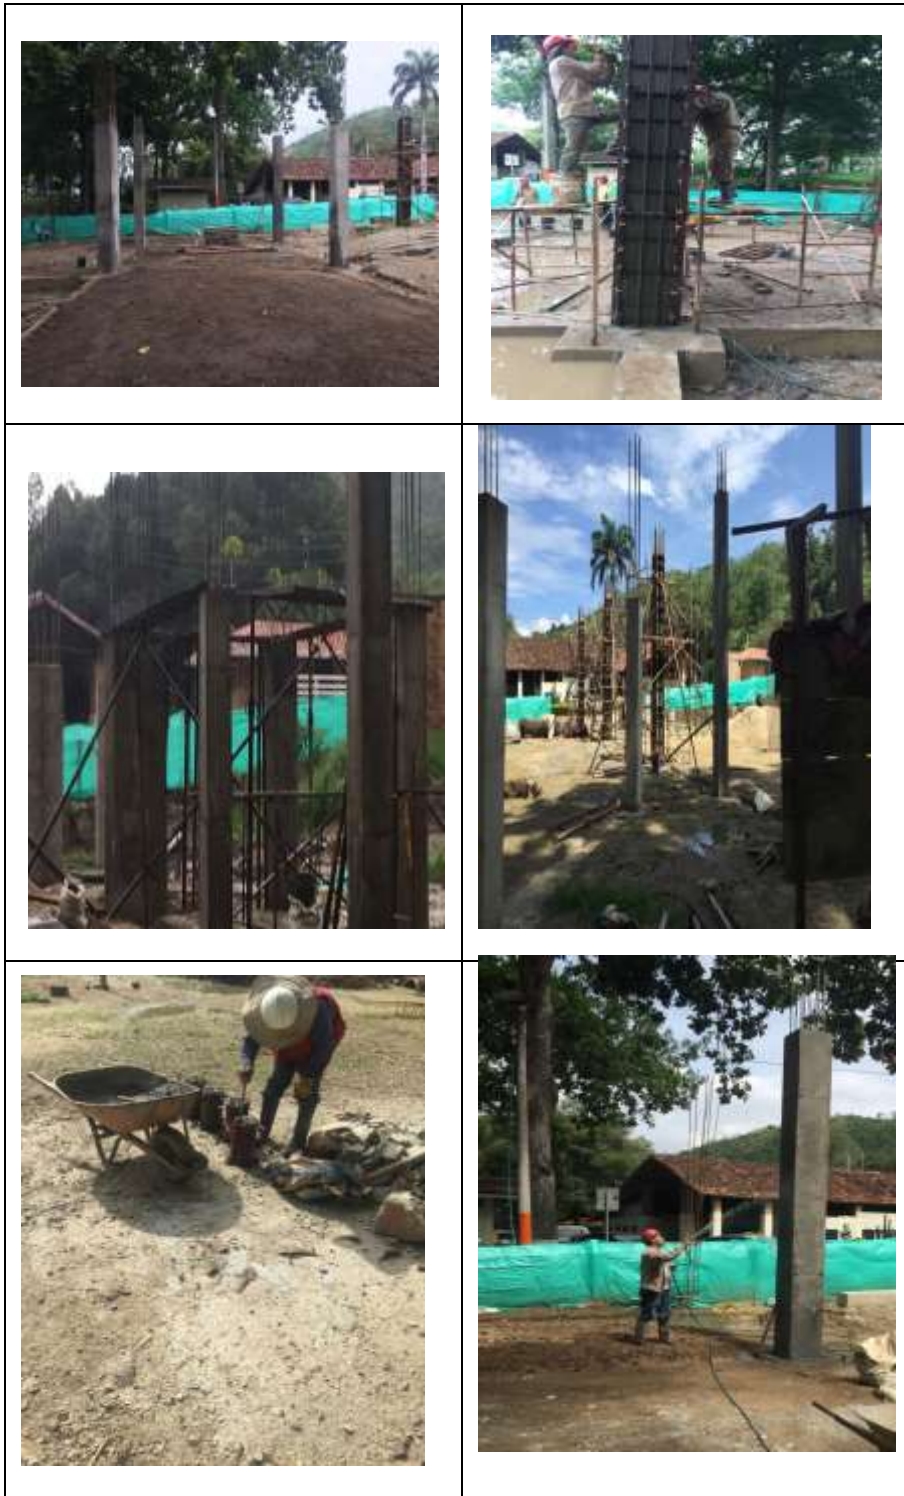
Memorias fotográficas de la instalación de la construcción de las columnas.
